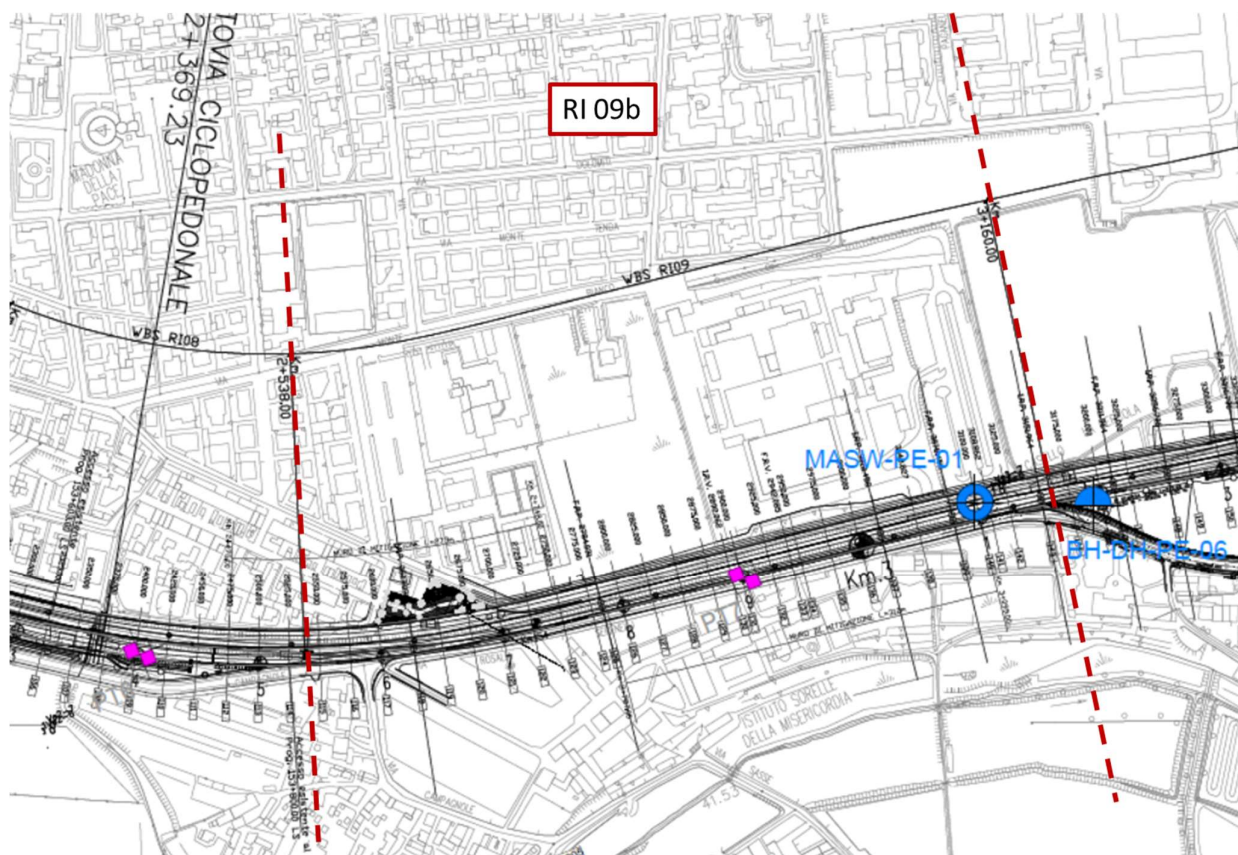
Planimetria Rilevato RI09B, estratto dalla Planimetria Generale (Doc. Rif. [3])
